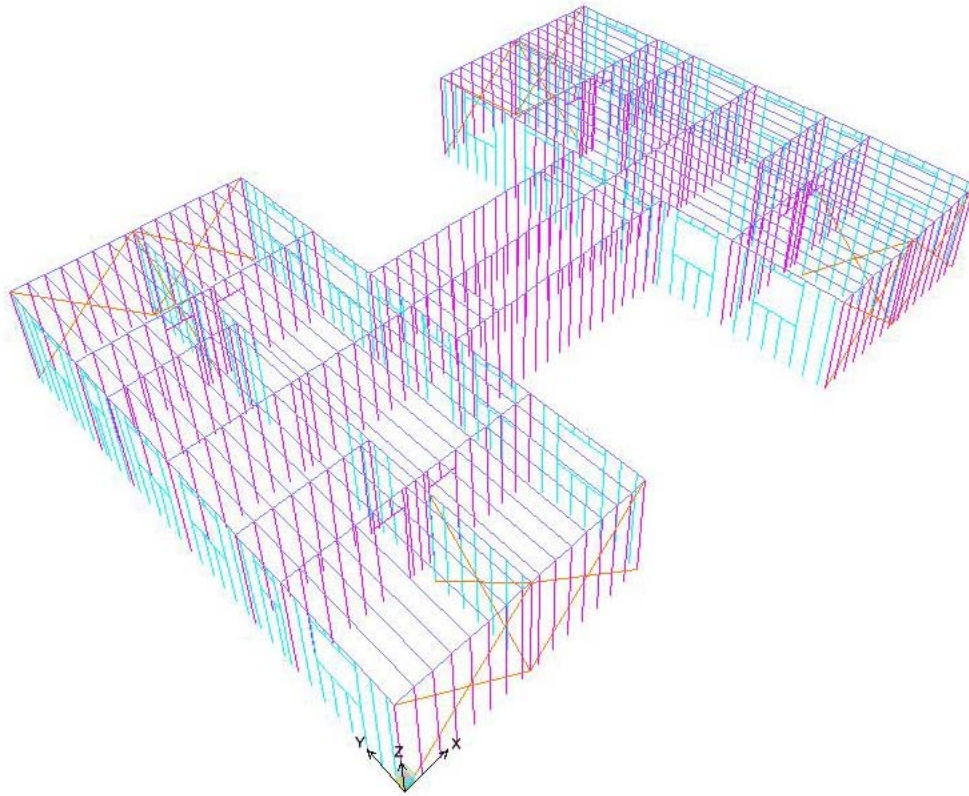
(a) – Modelo B-4-400-X-descont. pavimento-tipo unifilar.
